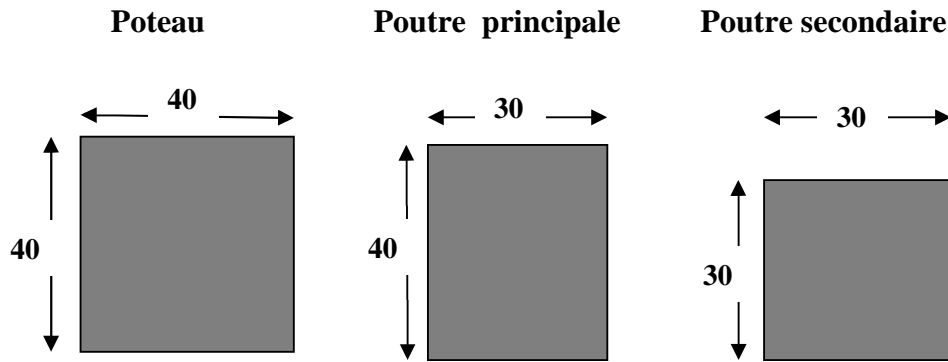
Dimension des sections de béton des poutres et des poteaux des trois structures.
